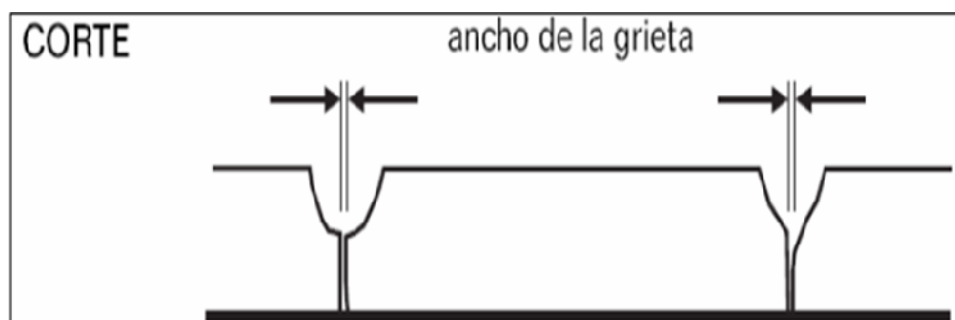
Corte transversal de una losa, mostrando ancho de grieta.
